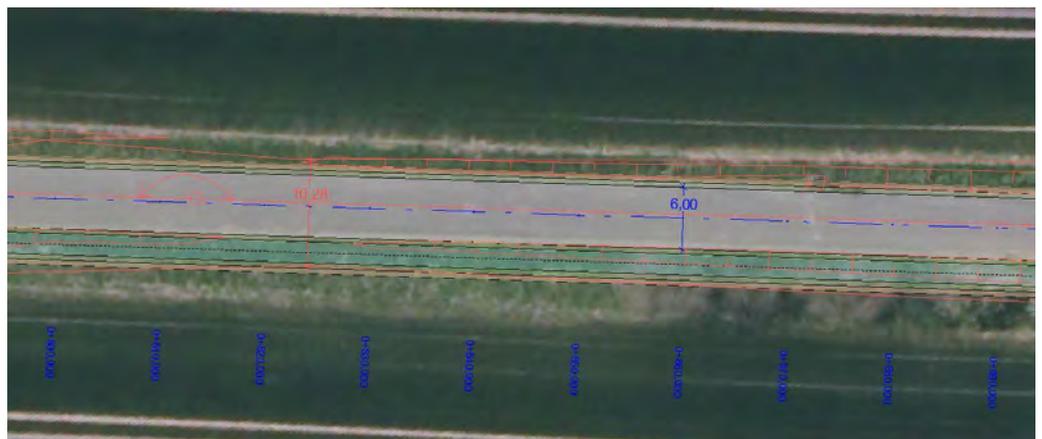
Querschnitt Q2 - Lageplanausschnitt
